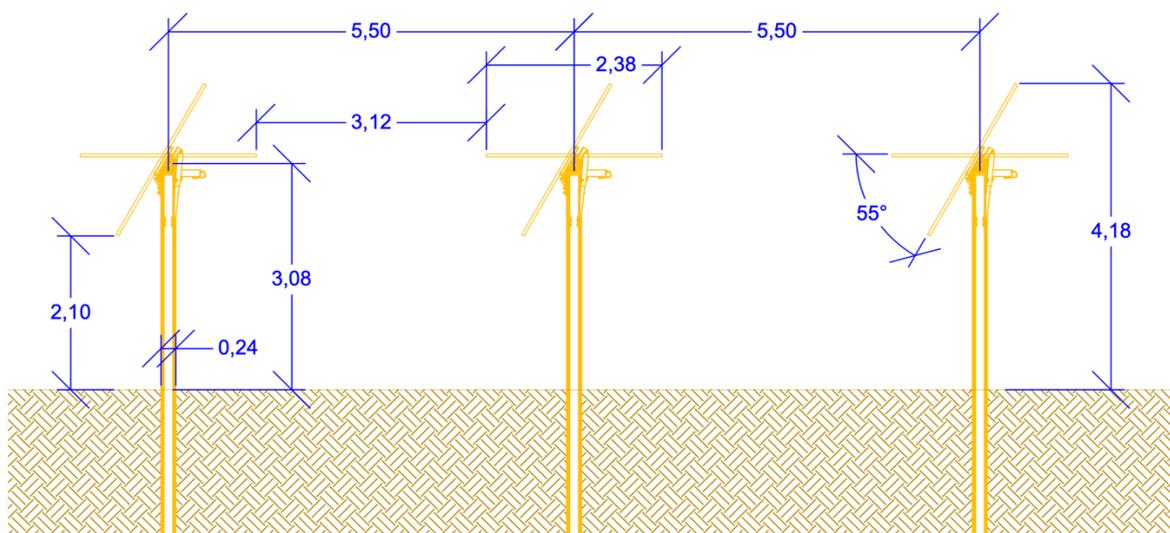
Vista delle strutture fotovoltaiche in sezione previste per il progetto.
